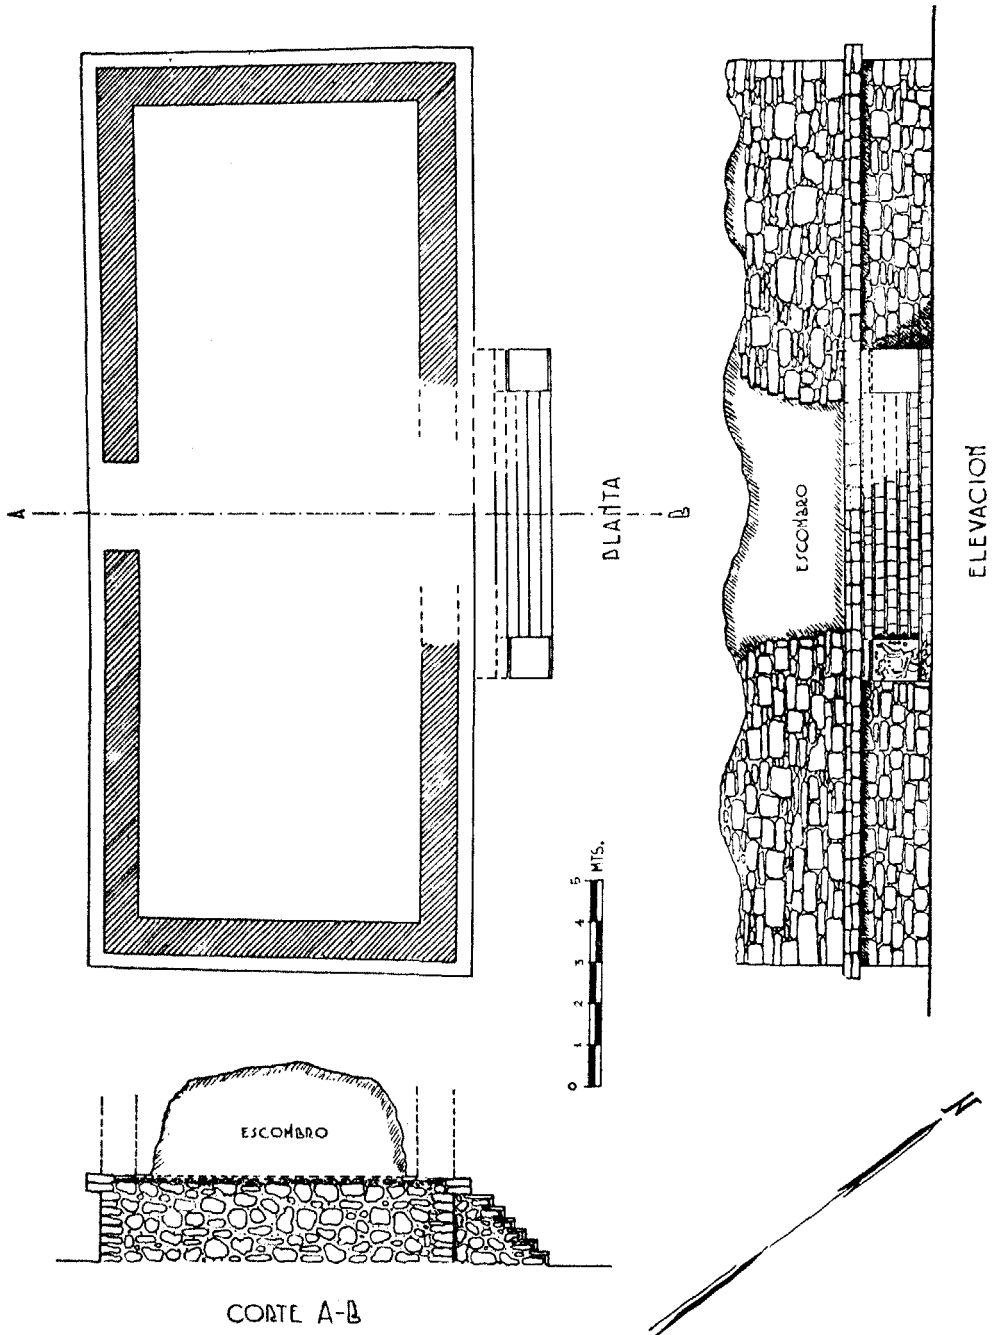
Templo XXI: planta exterior, elevación y corte transversal.
